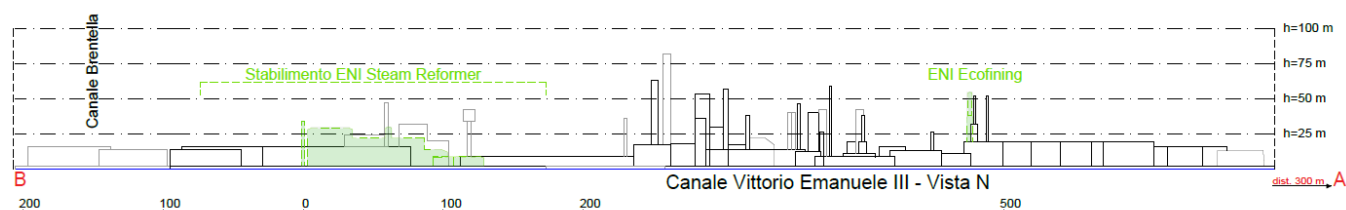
Sezione paesaggistica B-A (estratto Allegato A) – In verde gli impianti in progetto.
